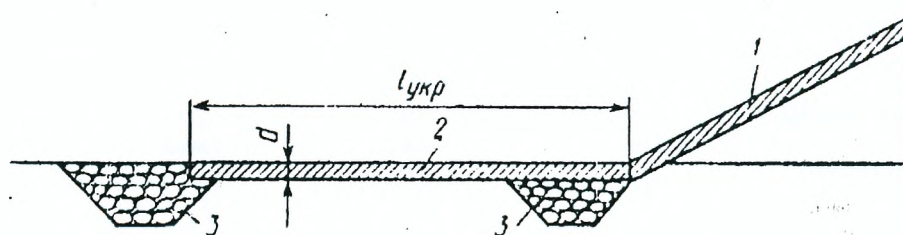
Укрепление дна у подошвы откоса: 1 – укрепление откоса; 2 – укрепление дна; 3 – каменная рисберма
